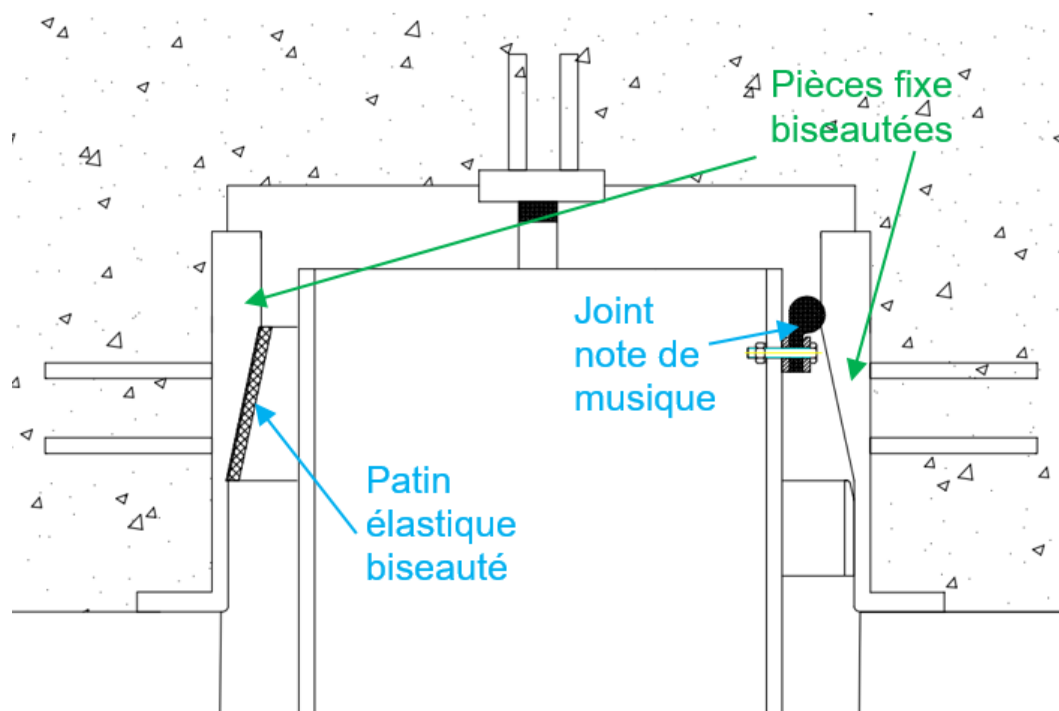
Croquis de la rainure Sud avec le système d'étanchéité et de plaquage du joint (angles biseautés volontairement accentués)
